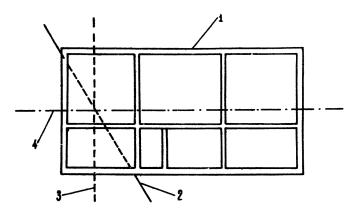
Схема выбора расчетных положений уступа в здании, орнентированном под углом к простиранию:
